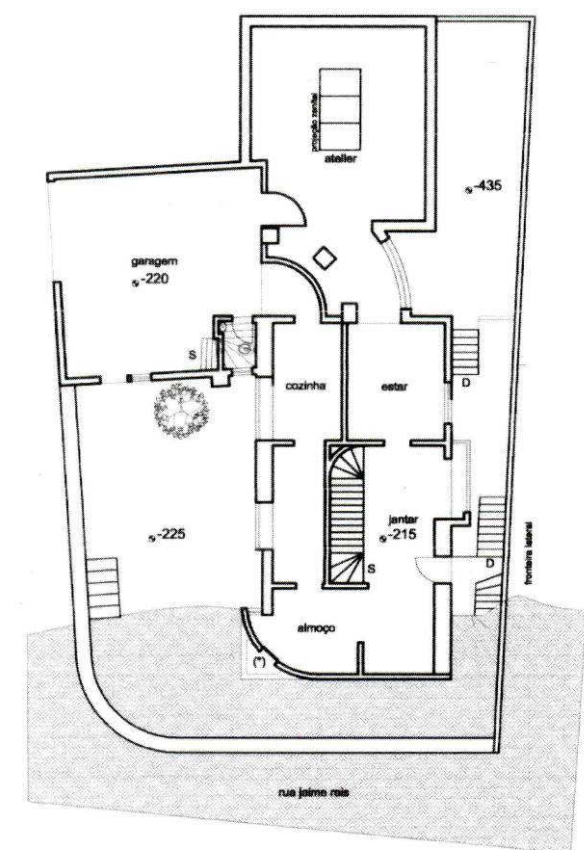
PLANTA DO PRIMEIRO PAVIMENTO
